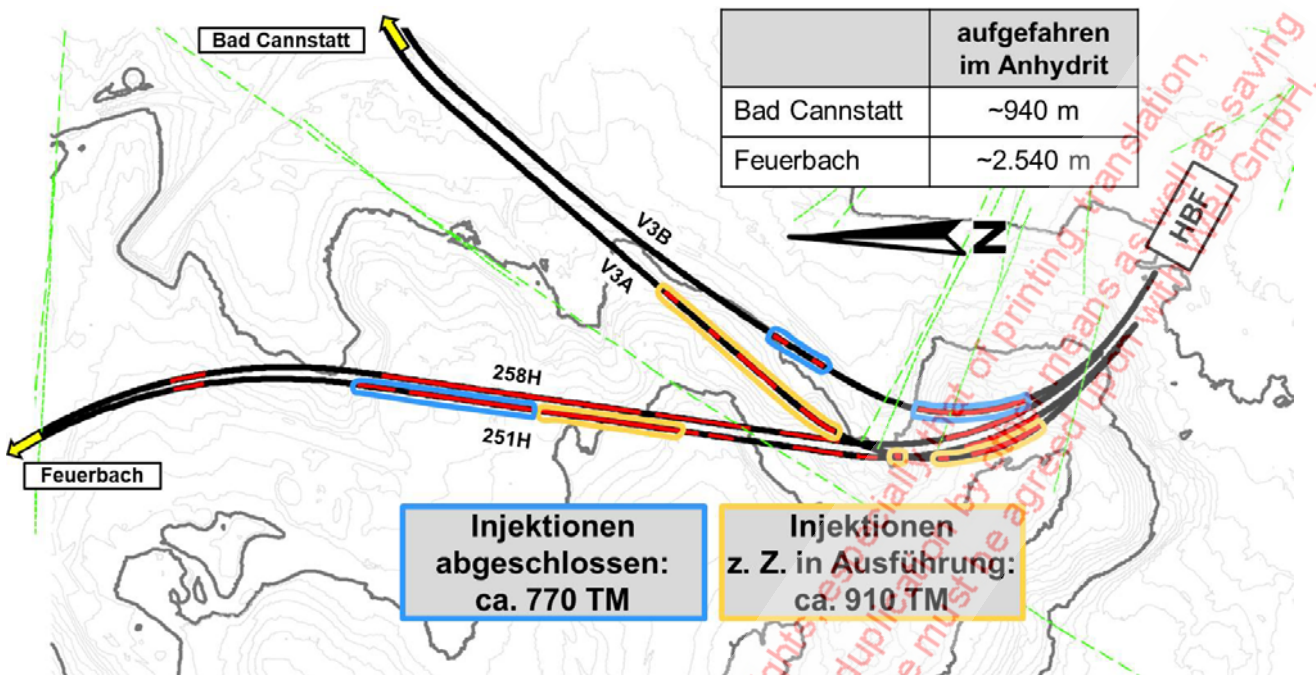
Lageplan mit Stand der Injektionen Anhydrit
